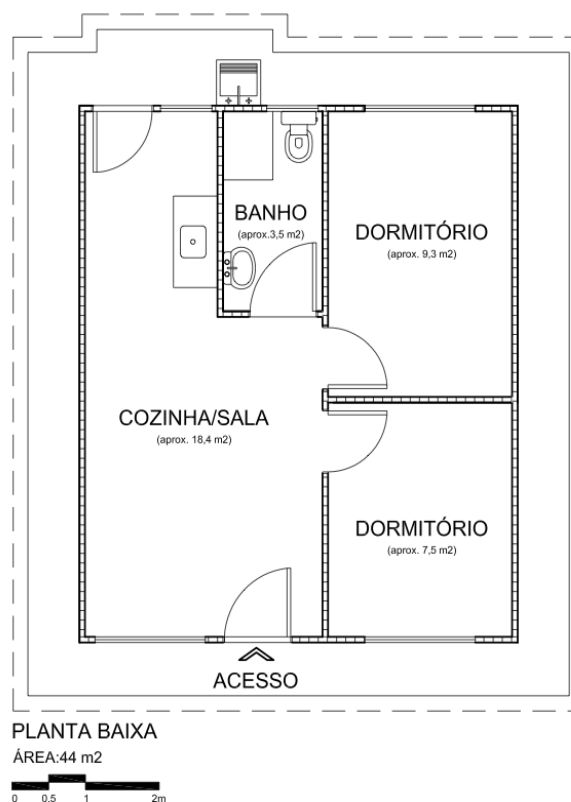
Planta baixa esquemática: Loteamento Canoas Minha Terra I e II.
